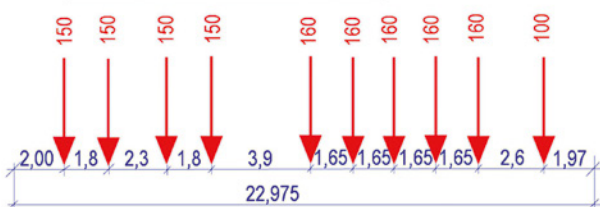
Dampf betriebene Betriebsfahrzeuge
